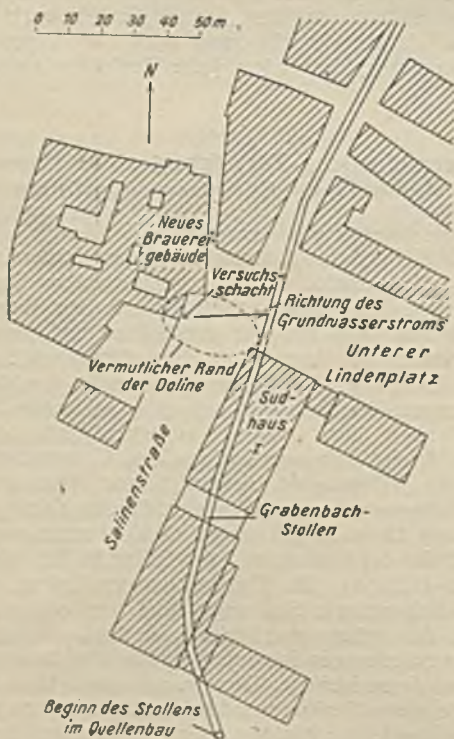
Lageplan des Senkungsgebietes in der Salinenstraße.
